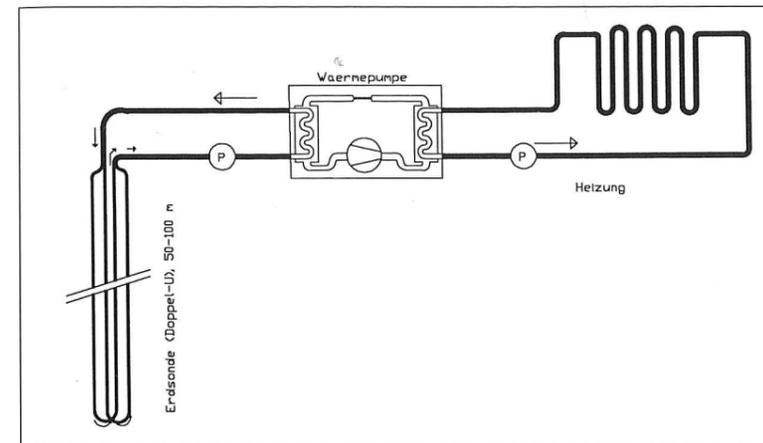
Schema einer typischen erdgekoppelten Wärmepumpe mit Erdwärmesonden für ein Wohnhaus
